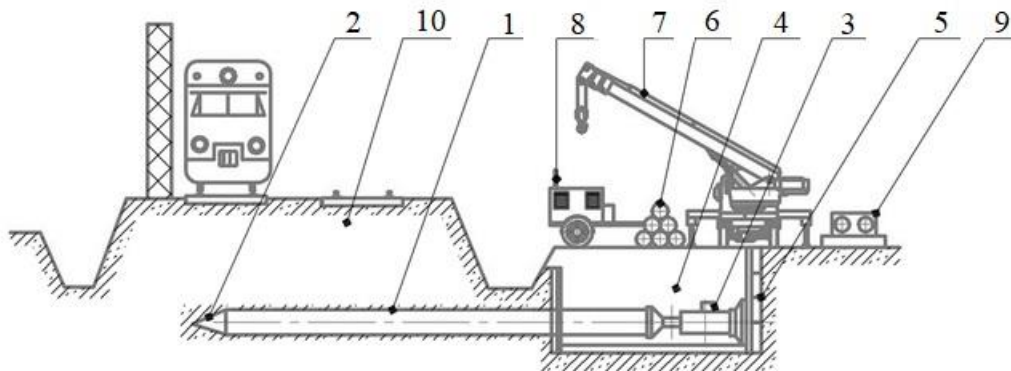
Схема статичного проколу під насипом залізниці: 1 – труба, що прокладається; 2 – робочий наконечник; 3 – гідродомкрат; 4 – робочий прямок; 5 – упорний щит; 6 – труби для прокладання; 7 – мобільний кран; 8 – зварювальний агрегат; 9 – гідростанція, для живлення домкрата; 10 – залізничний насип
